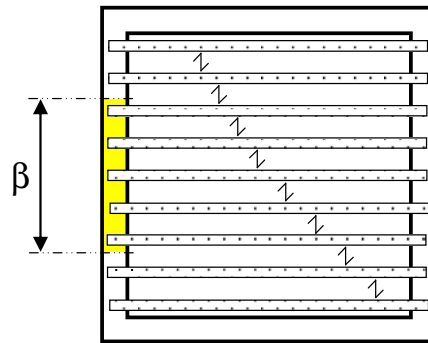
a. Solaio con travetti e tavolato (lo schema riporta l'orditura di quest'ultimo). I travetti sono supportati dai due muri paralleli. Due muri ortogonali sono ammorati ai predetti muri porta-travetti. Il solaio è dunque portato dai due muri porta-travetti, quest'ultimi controventati dai due muri ortogonali.
